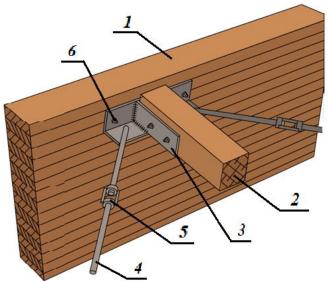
Крепление связей с деревянной распоркой и тяжами из круглой стали 1 - основная клееная конструкция (балка), 2 - примыкающая деревянная распорка связевой решетки, 3 - стальной сварной башмак с отверстиями в полках, 4 - тяж-раскос из круглой стали, 5 - натяжная муфта, 6 - сквозные болты с квадратными шайбами со стороны древесины
